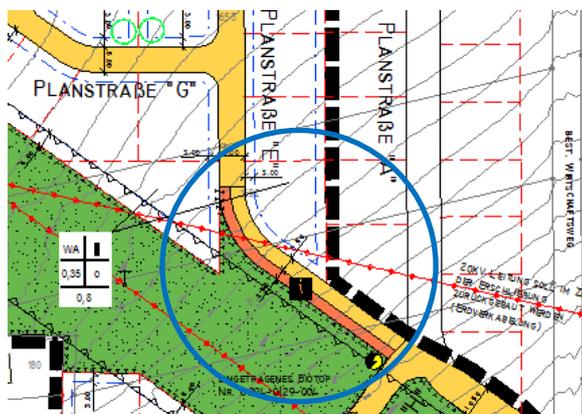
Planausschnitt „vorübergehende Zufahrt“
